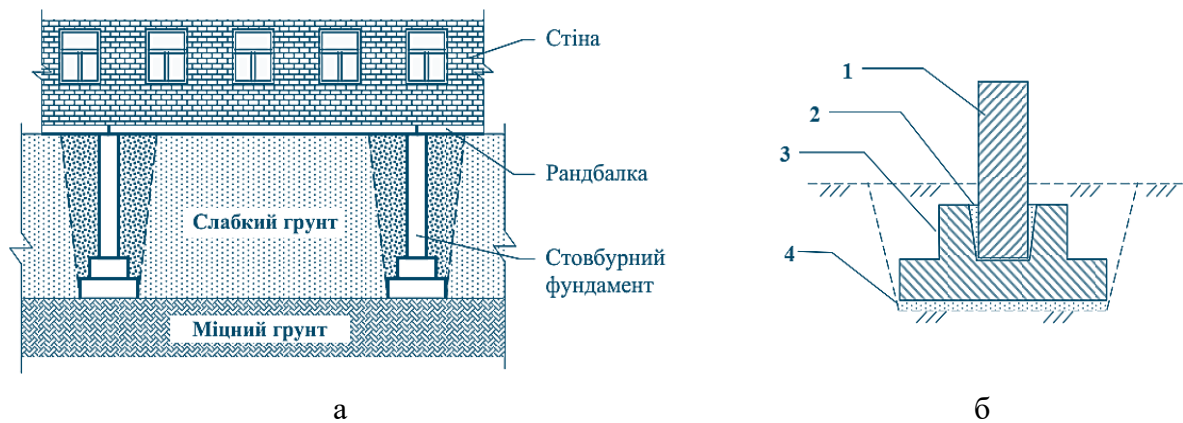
Приклад конструкції стовбурних фундаментів: звичайного (а) та стаканного (б) типу: 1 – колона; 2 – бетон; 3 – фундамент під колону (підколонник); 4 – бетонна підготовка
